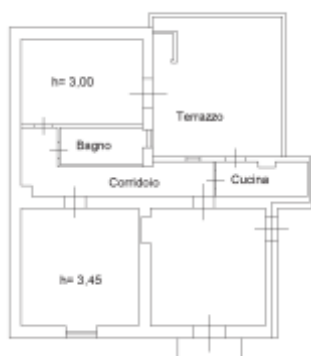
planimetria catastale dell'appartamento al primo piano – p.la 5021 sub 6
